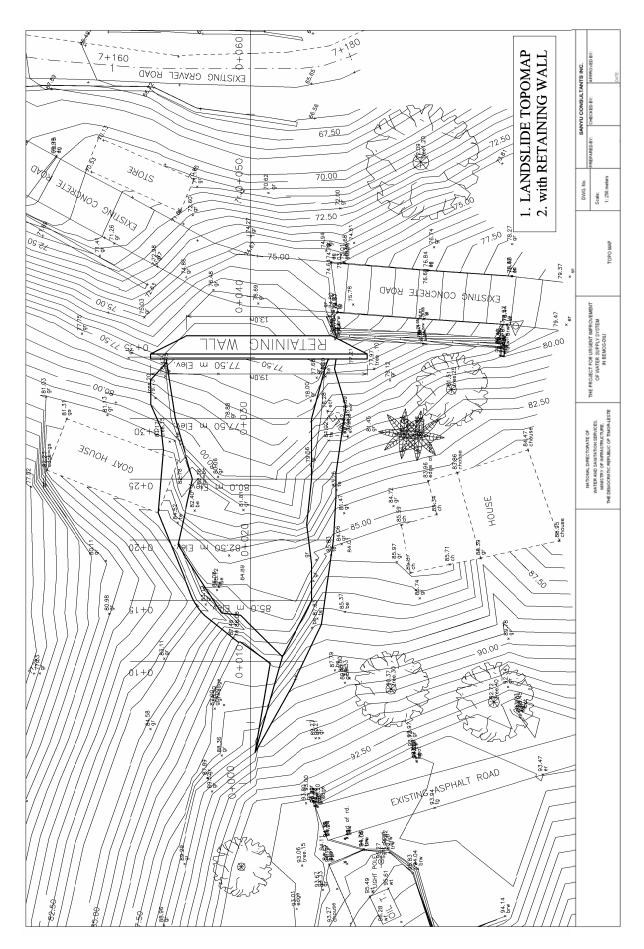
改修箇所 No. 15 ベモス浄水場アクセス道路地滑り対策工(計画平面図)
